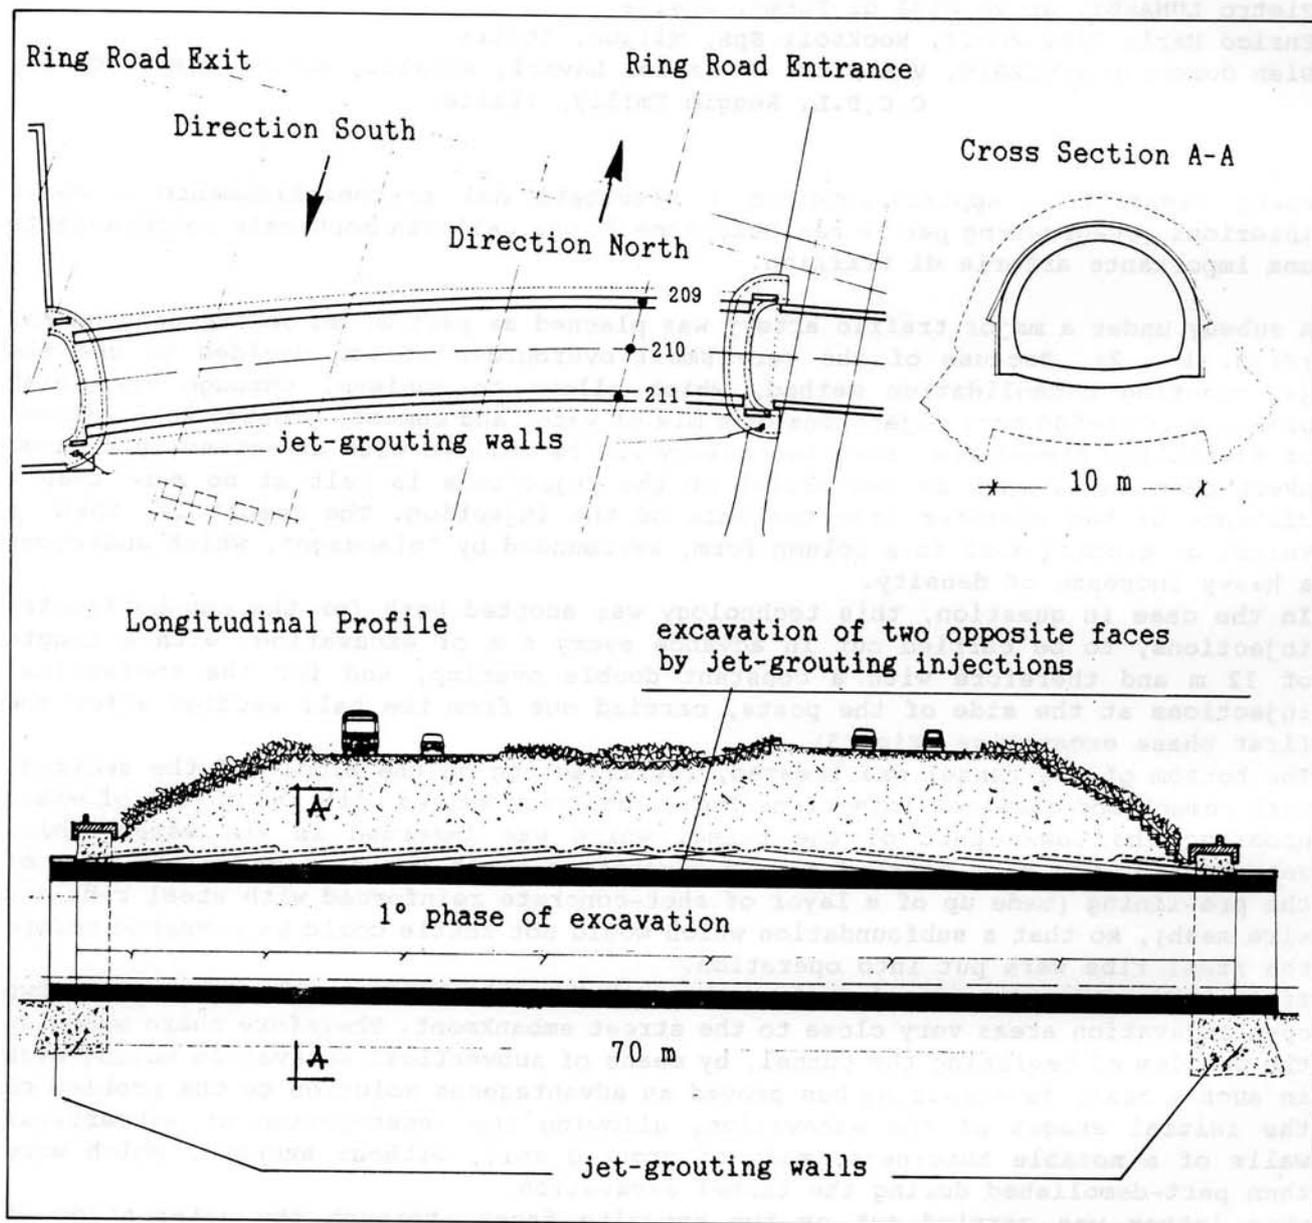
Planimetria, sezione trasversale e profilo longitudinale della galleria. Tunnel plan, cross section and longitudinal profile.
